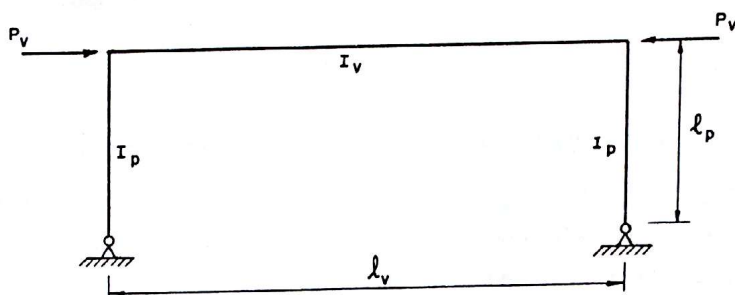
PÓRTICO BI-ARTICULADO COM PROTENSÃO SÓ NA VIGA
